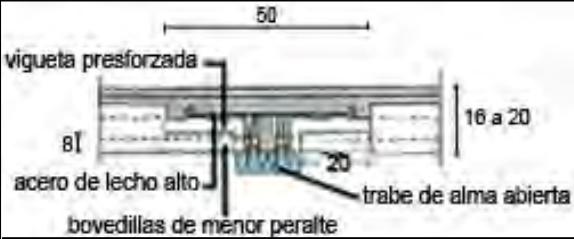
Apoyo con capitel en franja equivalente a una bovedilla rebajada de 20cm de ancho.
